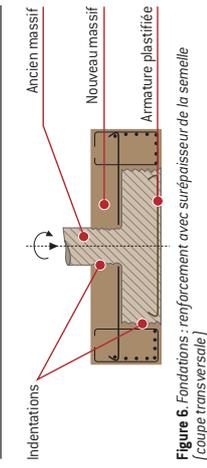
Fondations : renforcement avec surépaisseur de la semelle (coupe transversale)
